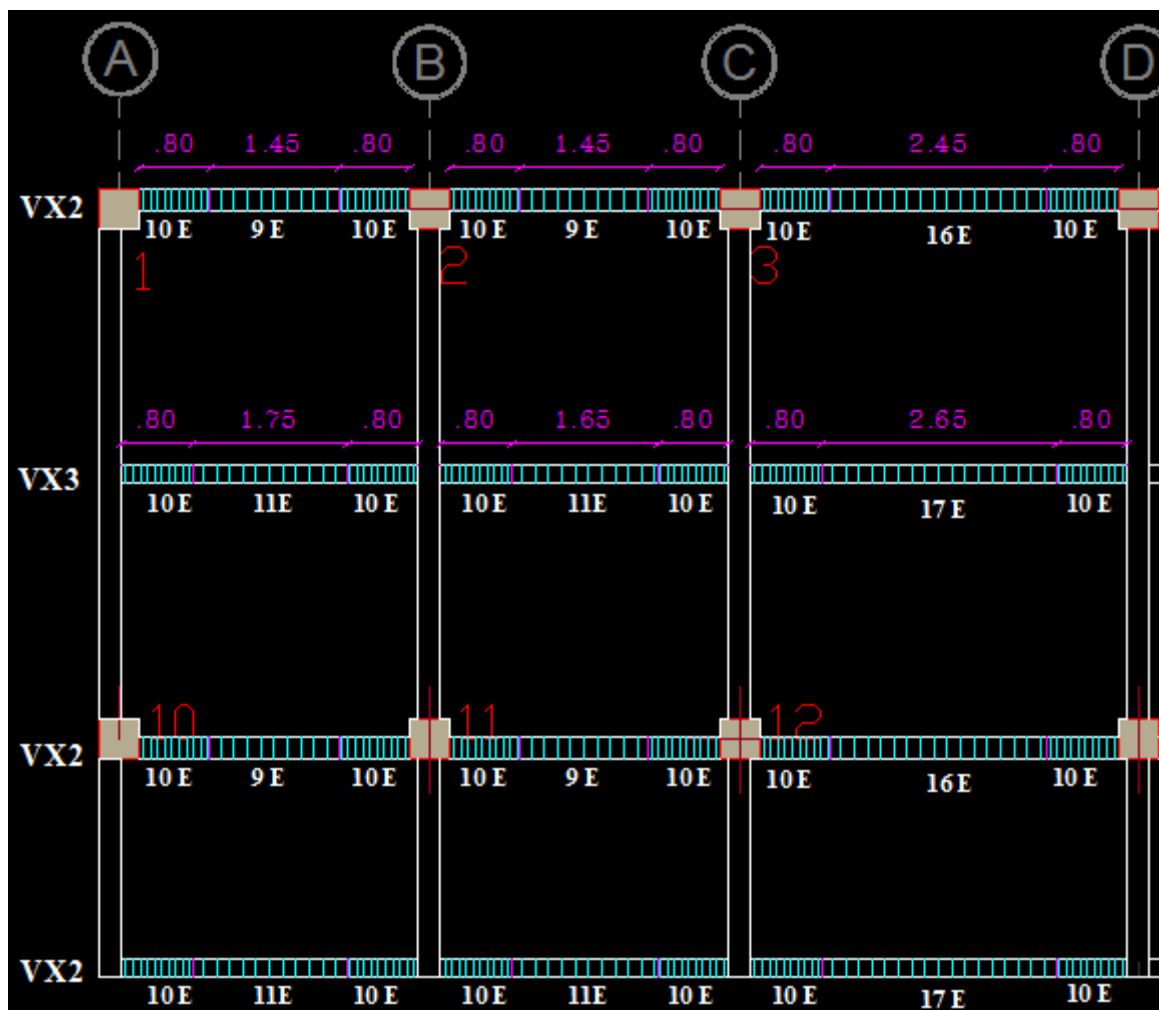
Ubicación de estribos en vigas en la dirección X, N+7.20.
